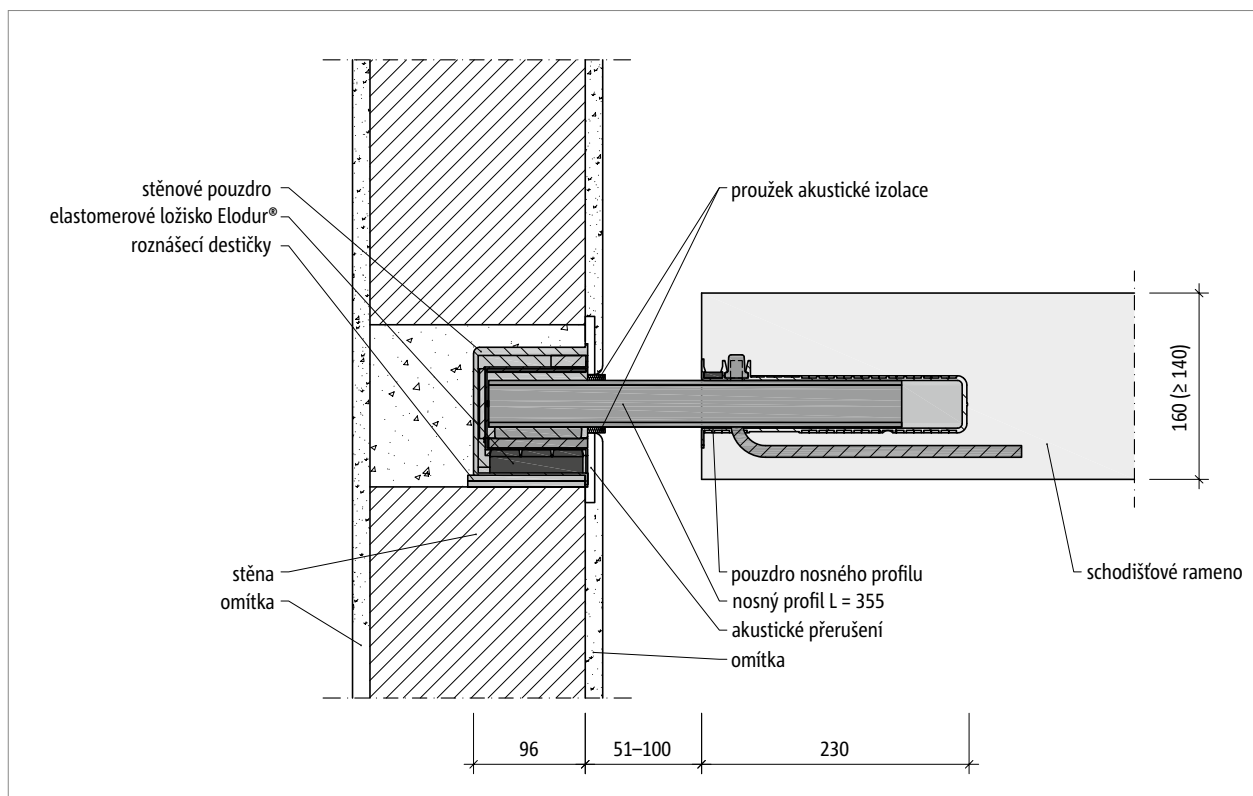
Schöck Tronsole® typ Q-FV-XL nebo Q-A2-XL: Řez
